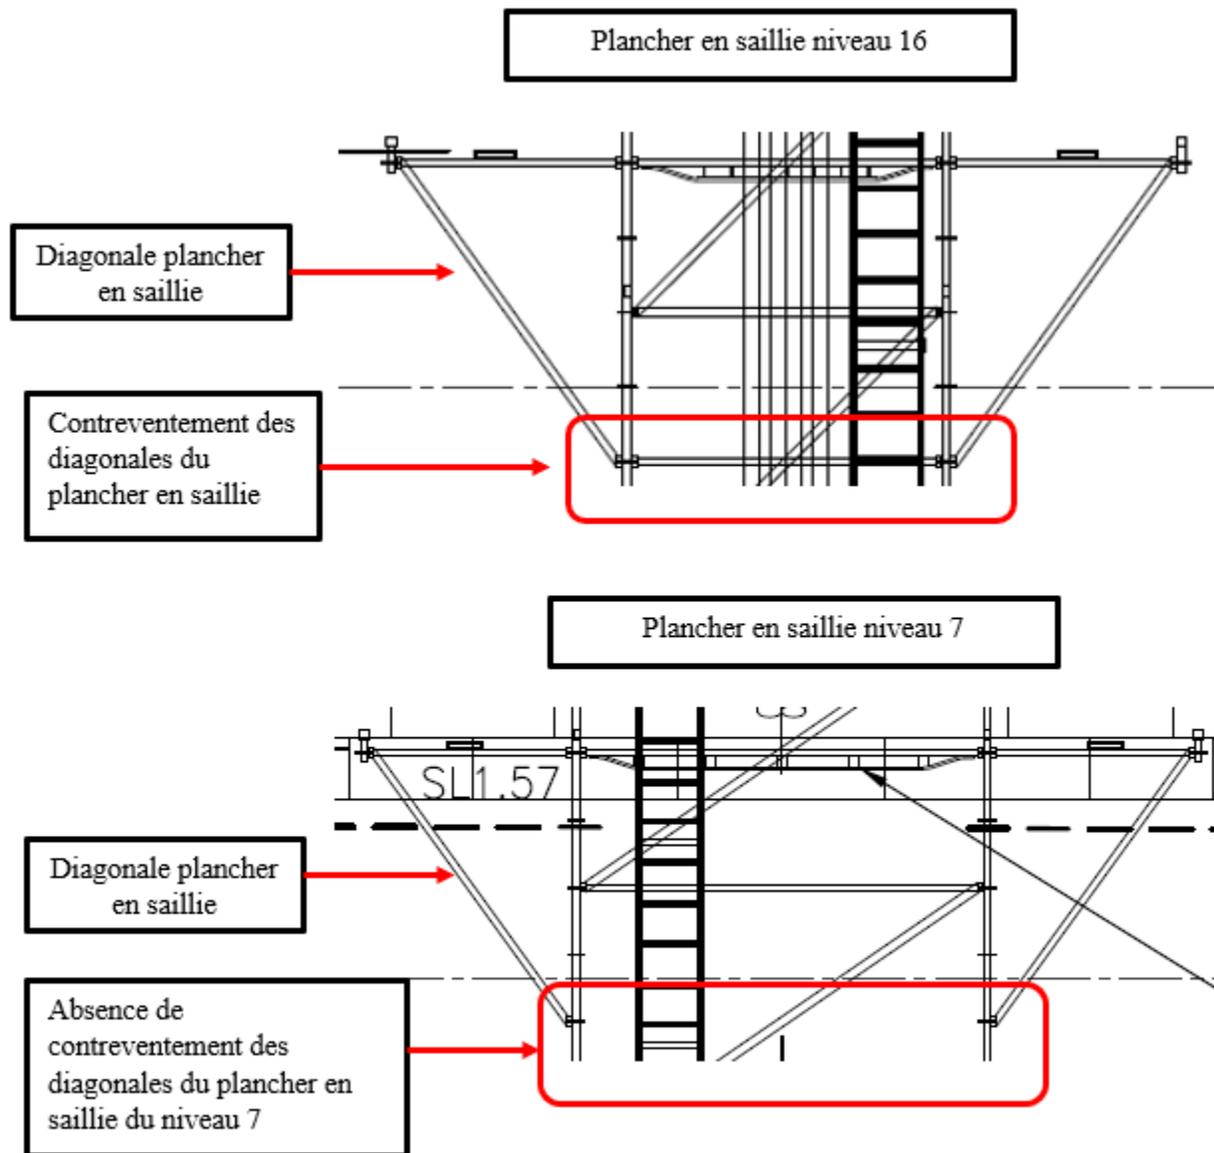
Niveaux de plancher en saillie avec et sans contreventement
